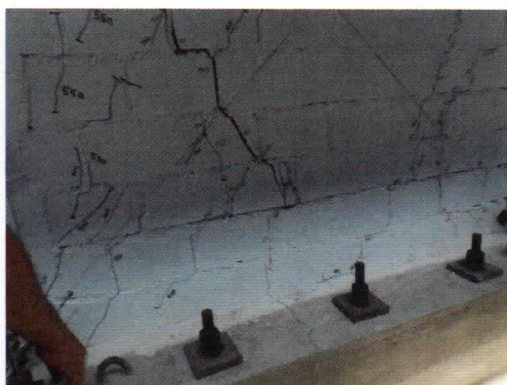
Desprendimiento de ladrillo en la zona inferior Este de la cara Norte para una distorsión de 1/300.
